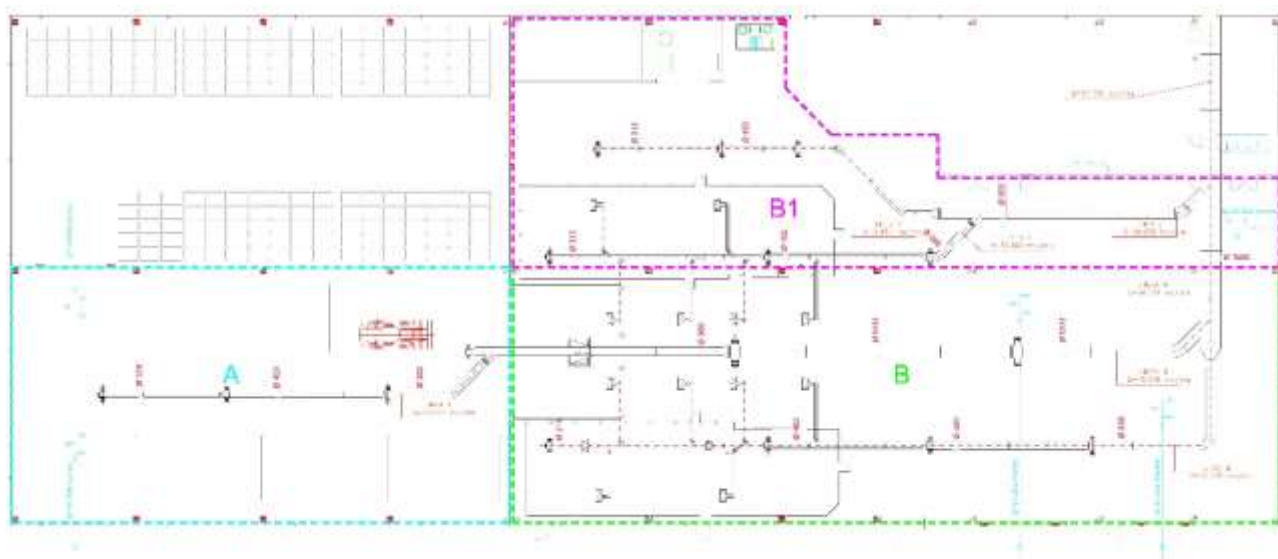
Pianta Impianto aspirazione e Trattamento arie esauste
